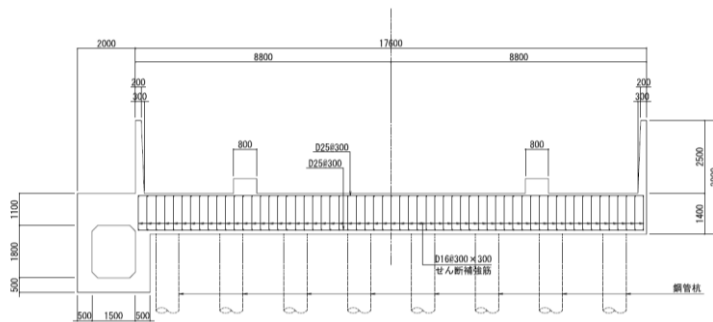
(1) 軽油タンク基礎 (6号機設備) の概略配筋図 (A-A断面)
